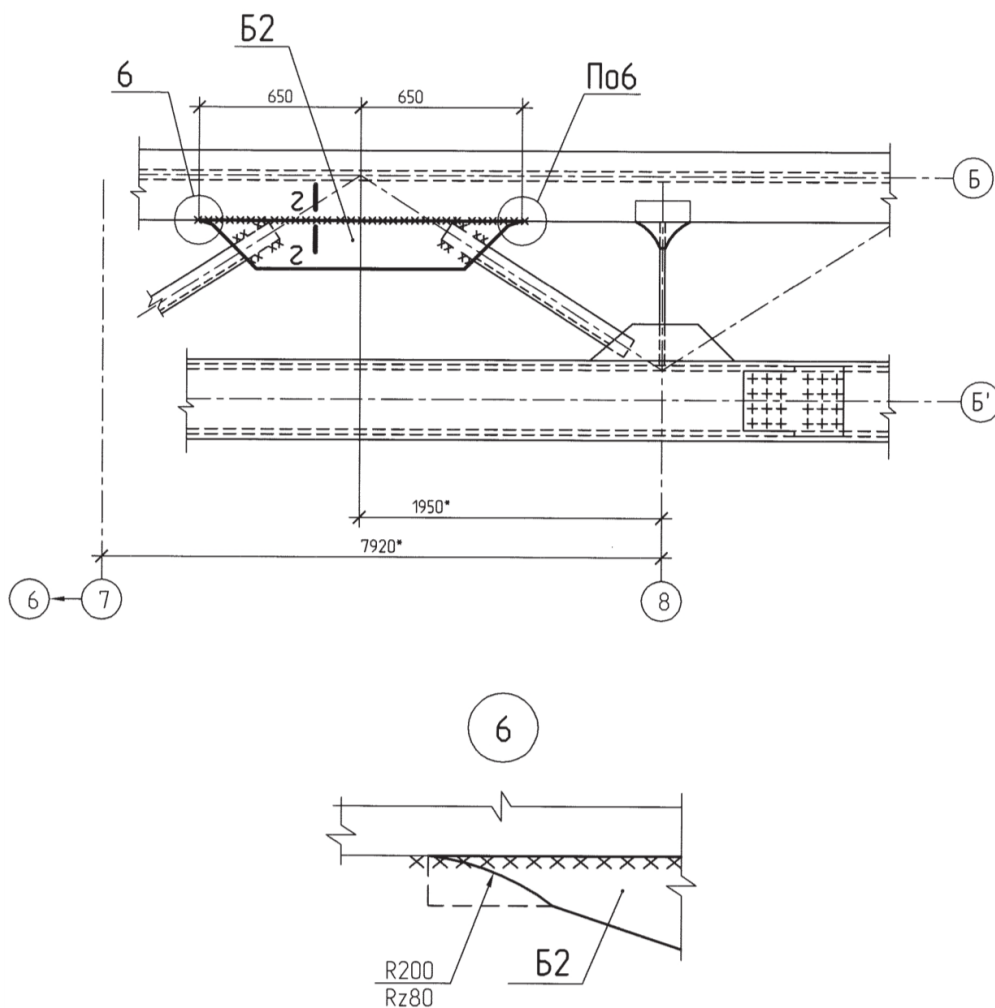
Узел крепления фасонки к верхнему поясу ездовой балки (к фото 3)
